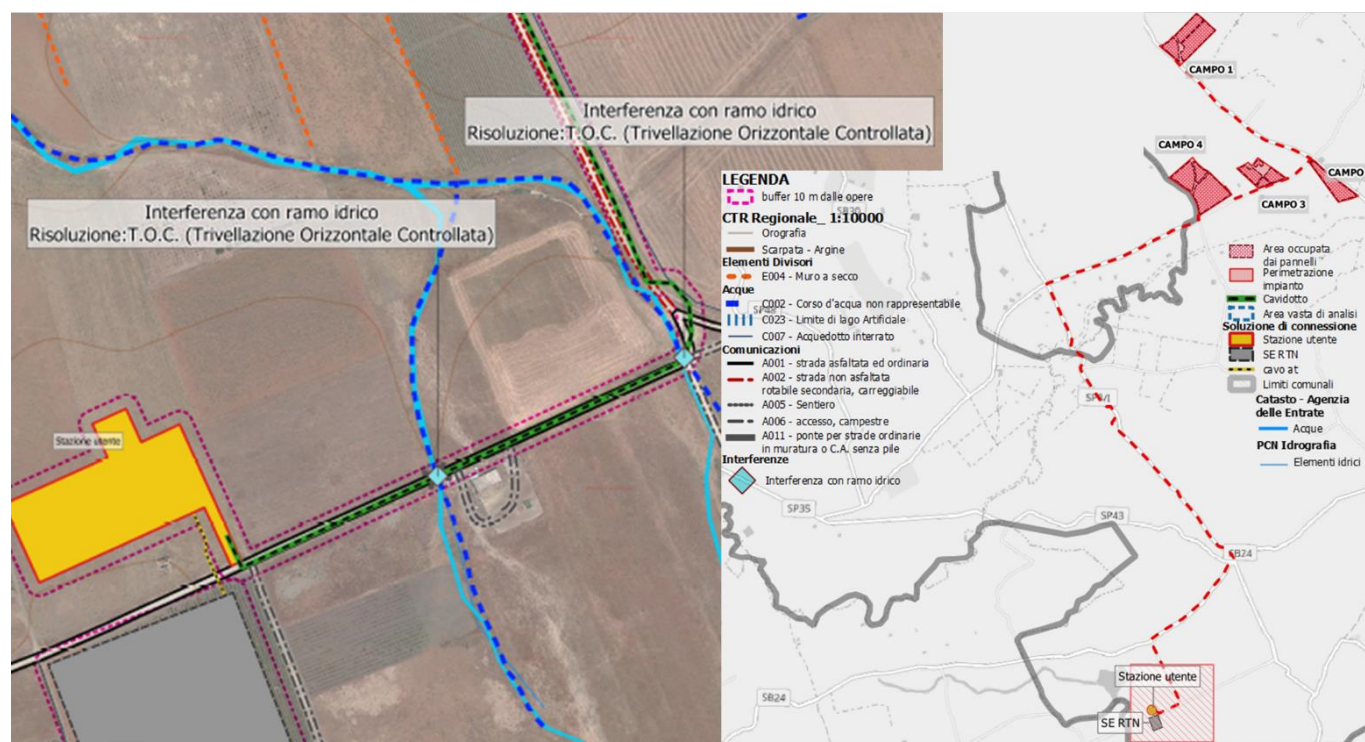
stralcio planimetria con indicazione interferenze tra ramo idrico e cavidotto
